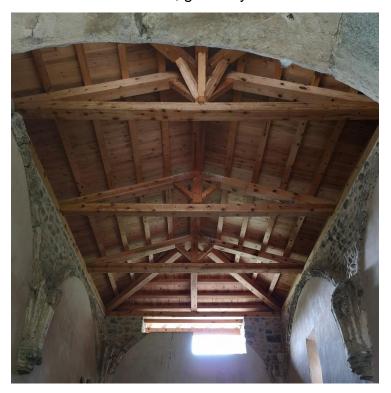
Ermita de San Lázaro. Cubierta interior y arranques de crucerías. (Fotografía de la autora)
